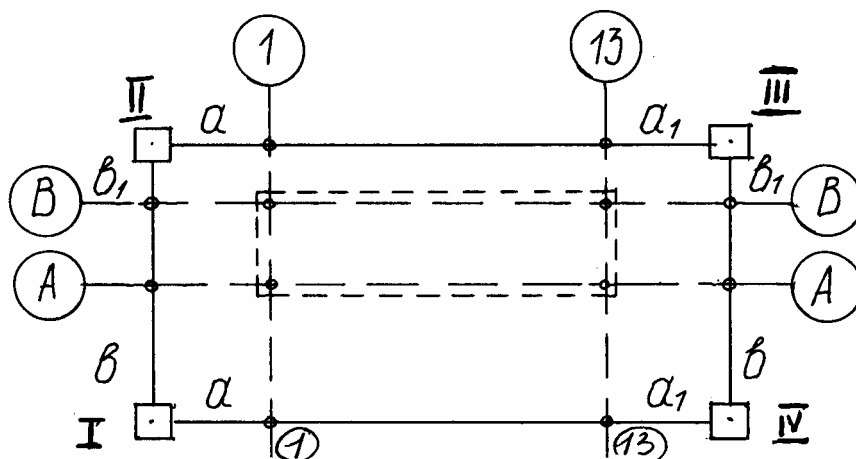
Схема перенесения в натуру осей здания от строительной сетки способом створной засечки
